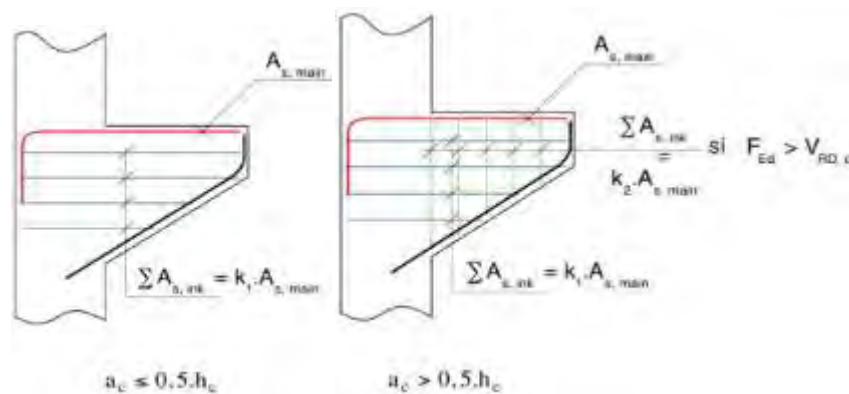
К расчету армирования консоли вертикальными хомутами
